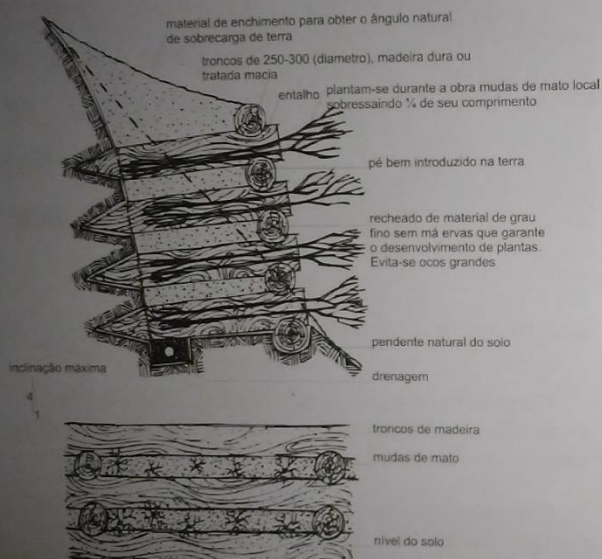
Muro de contenção construído com troncos de madeira bruta encaixados.
